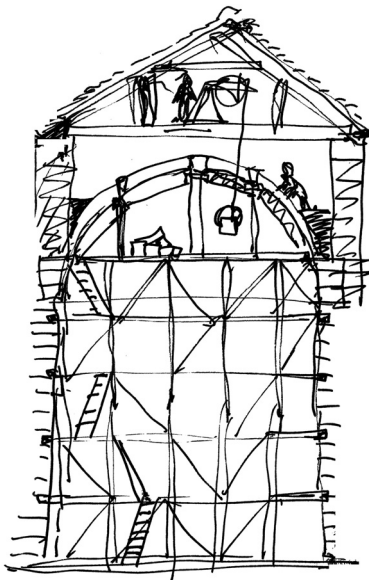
Croquis de una bóveda en construcción. Se ve el andamio principal, las cimbras y pies derechos que apoyan sobre él, y el tejado donde se ha dispuesto una grúa (autor)
